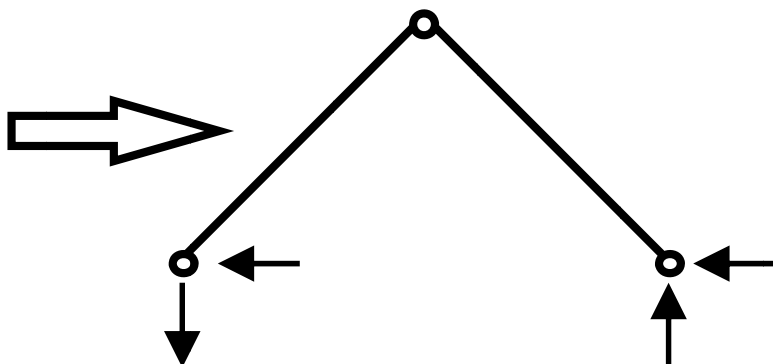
Carichi orizzontali, trasversali rispetto al colmo, sul sistema strutturale del tetto a puntoni
